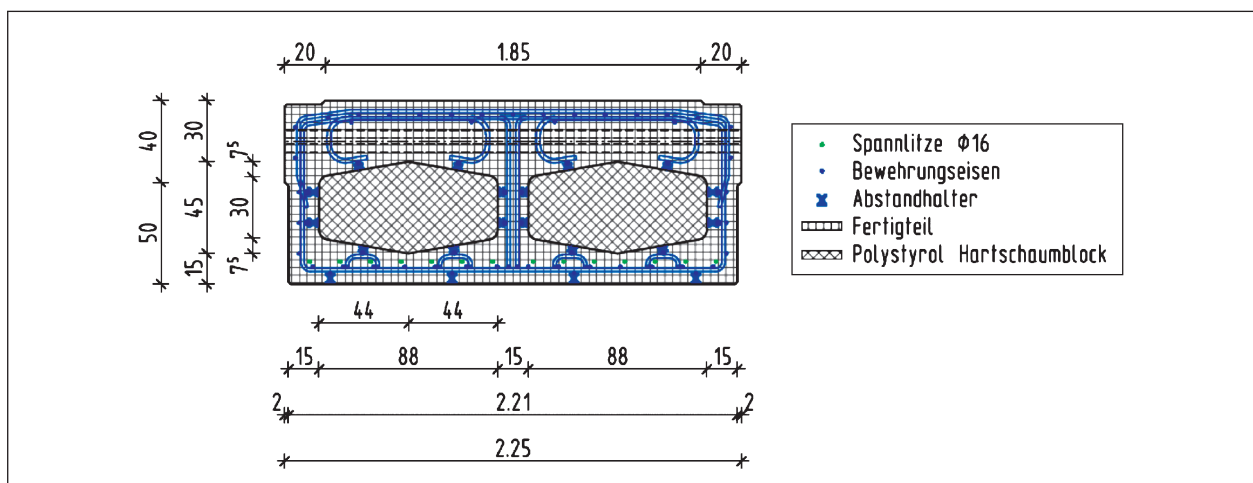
Details Variante 2 – Stahlquerschnitt Fertigteil mit Hohlkörpern durch Hartschaumblöcke
